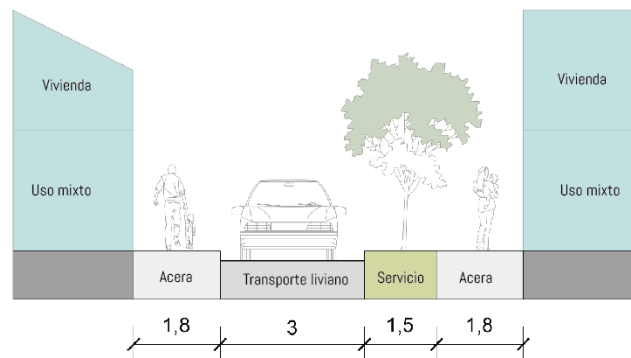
Sección de vía secundaria transversal. Fuente: Elaboración propia.
